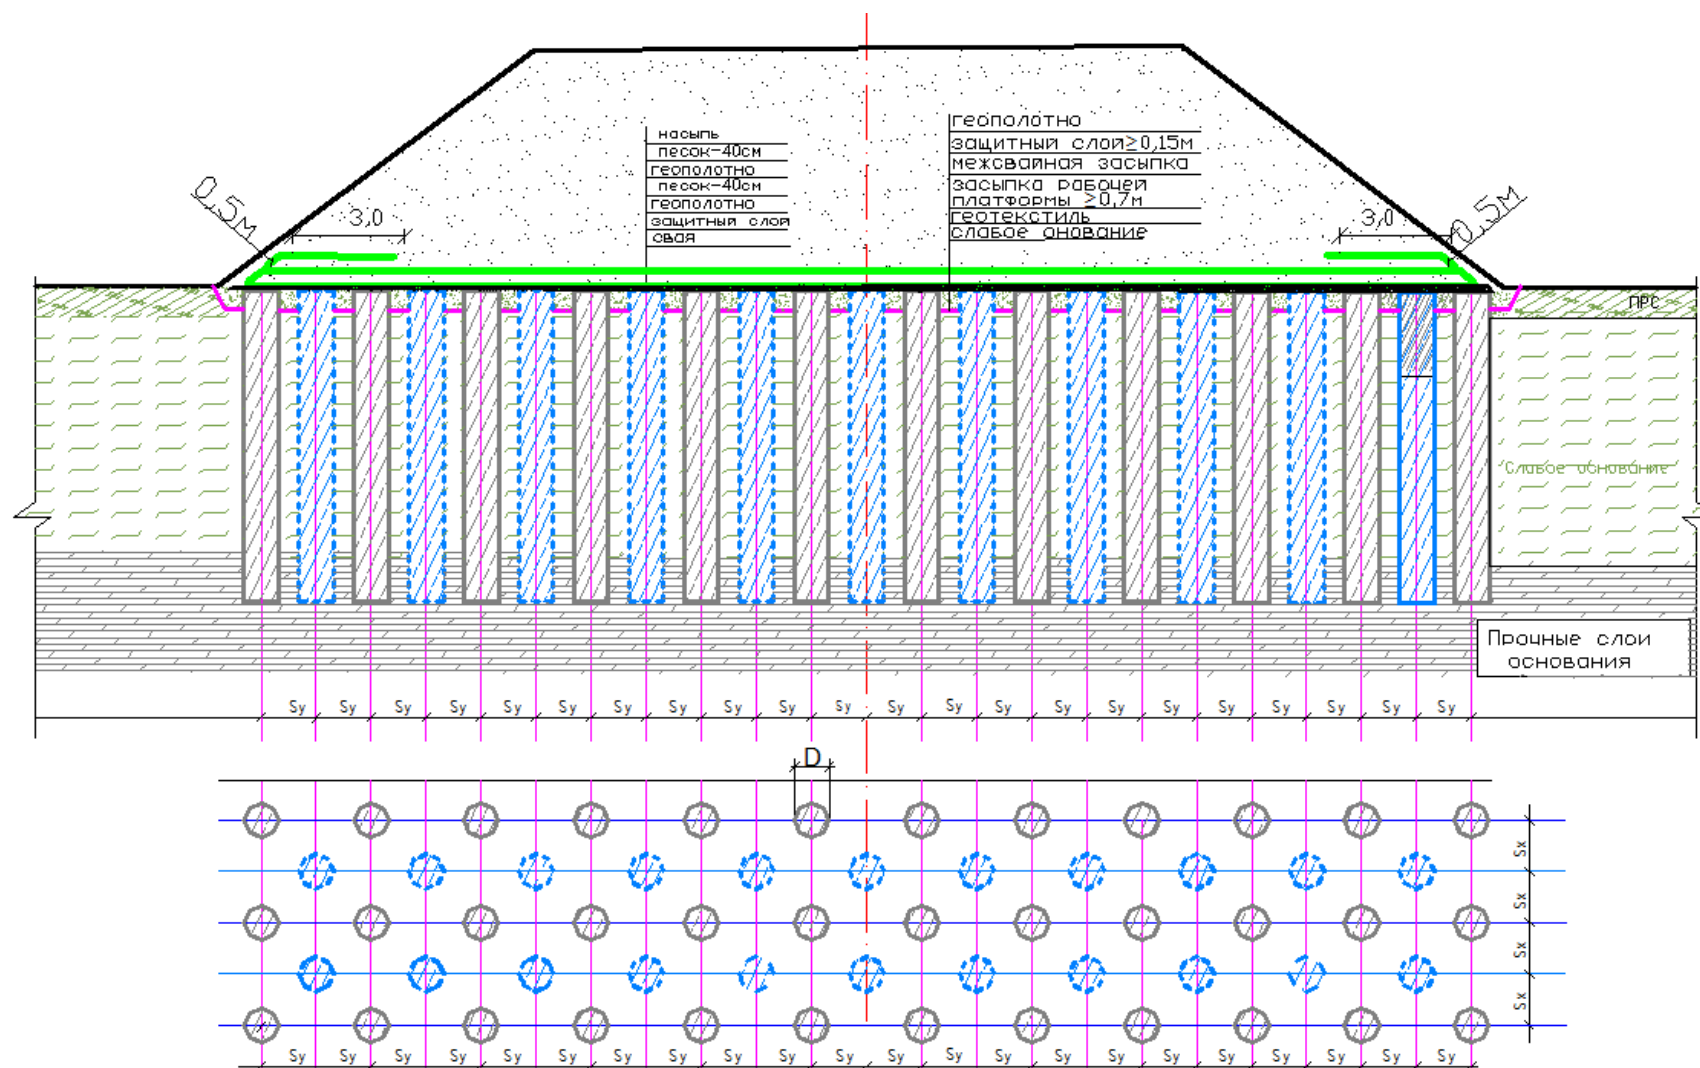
Гибкий ростверк из двух слоев геополотна с песком на круглых сваях (с размещением свай по треугольной сетке «в шахматном порядке»)
